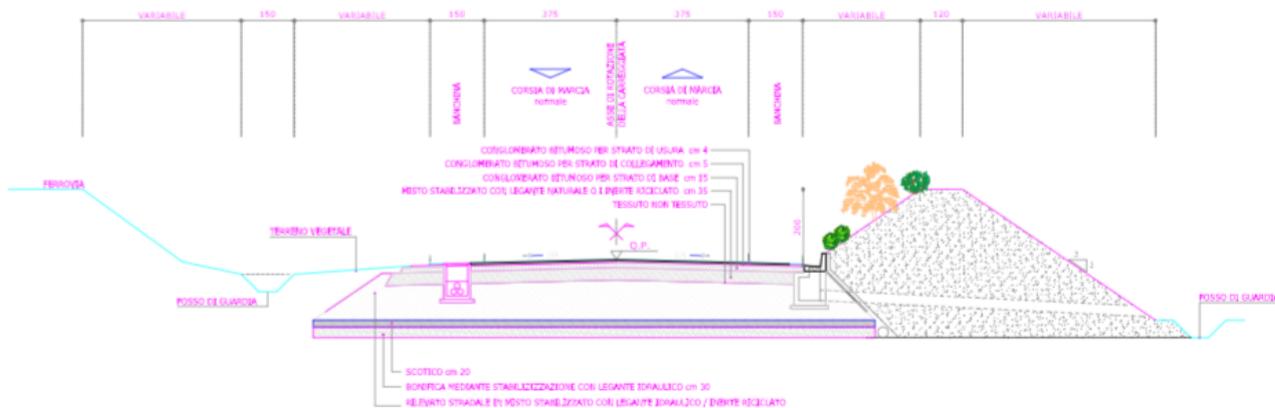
Sezione tipo nel tratto tra i nodi 1 e 2 – Progetto Preliminare: terrapieno "tipo dune"
